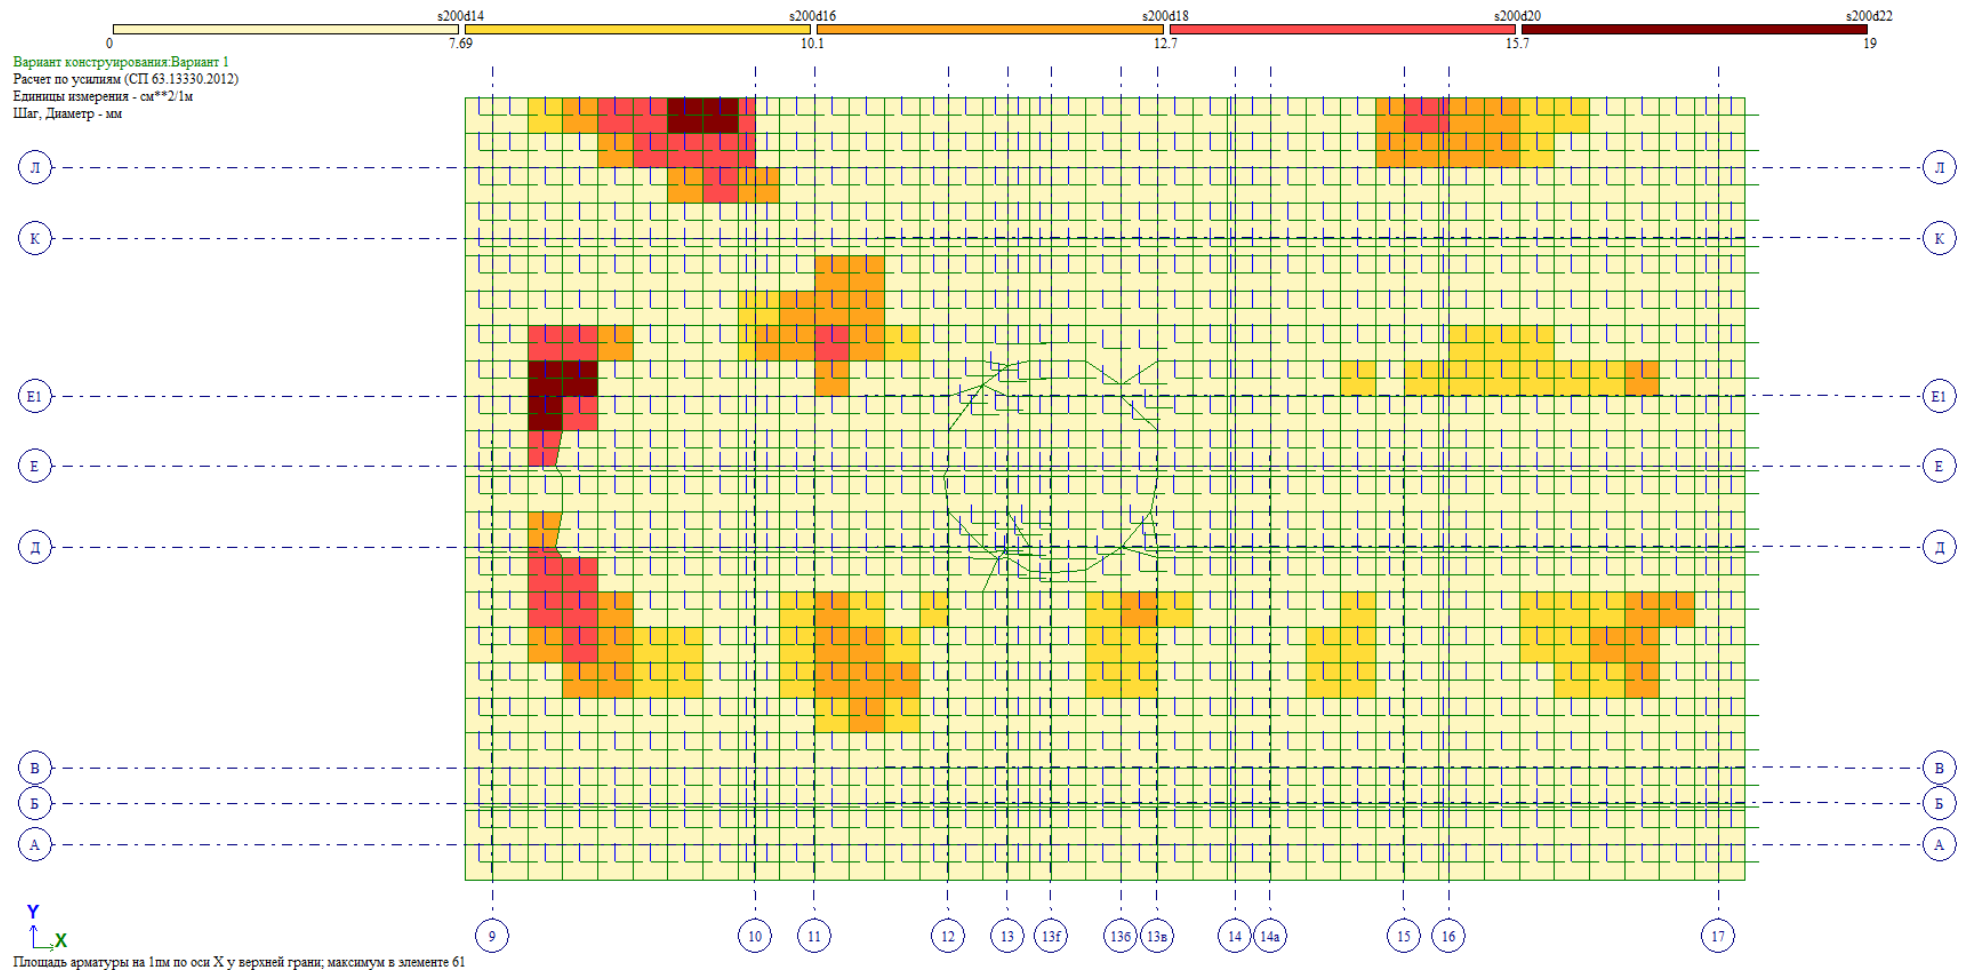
Площадь арматуры у верхней грани фундаментной плиты по оси X (карстовая воронка расположена в осях 13/Е секции В)
